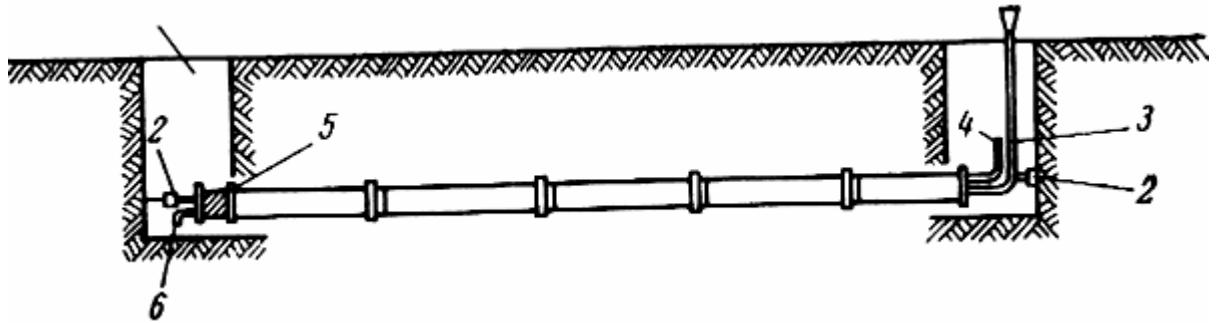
Схемы испытания трубопровода на внутреннее давление
